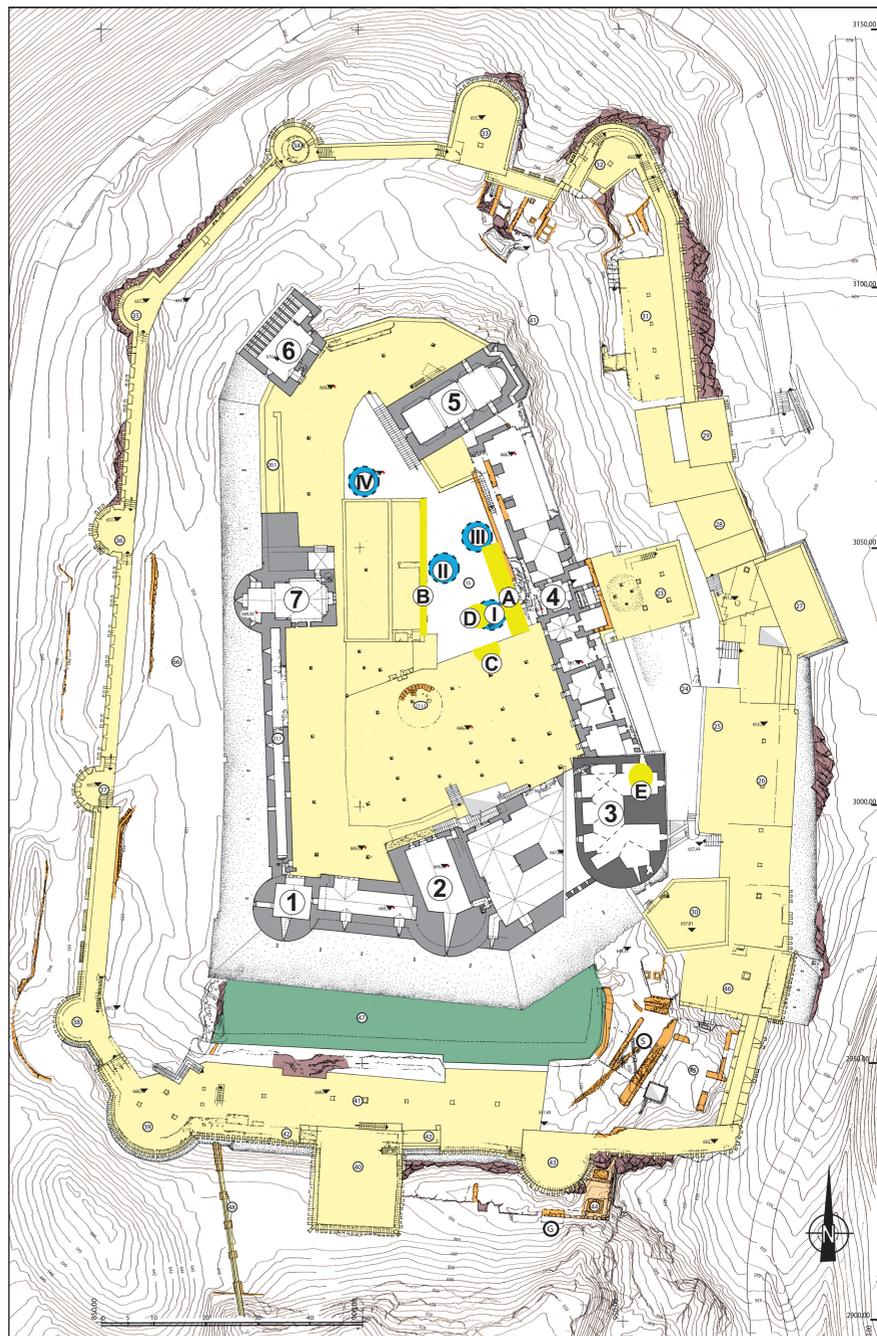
Grundriss mit den oberen Turmgeschossen.
